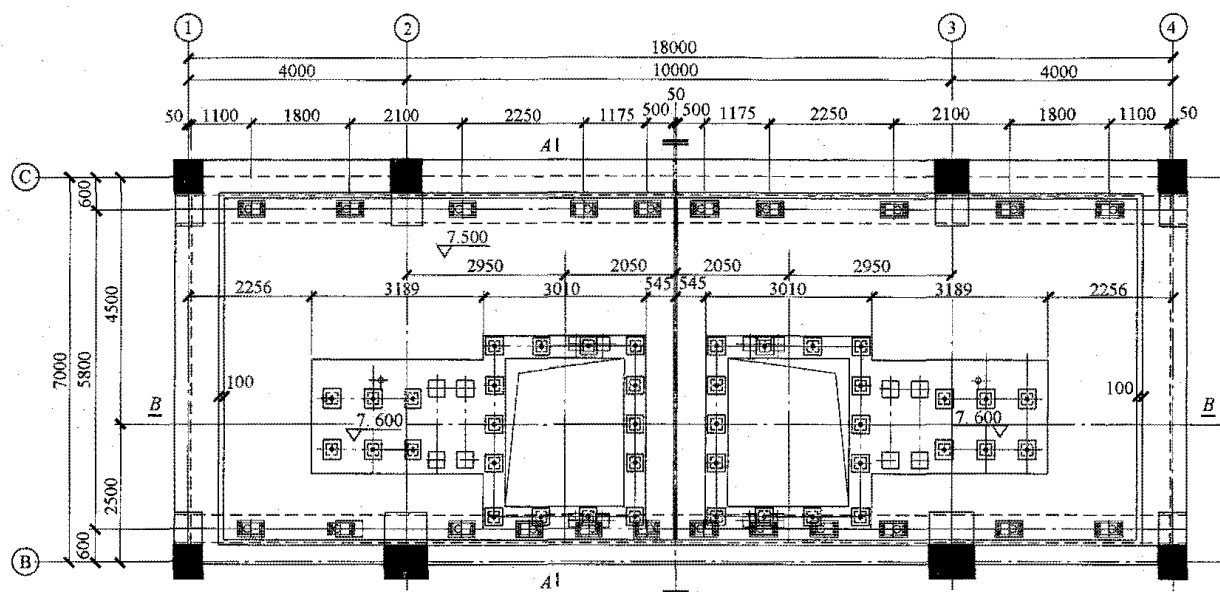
碎煤机弹簧隔振基础台板平面布置图
